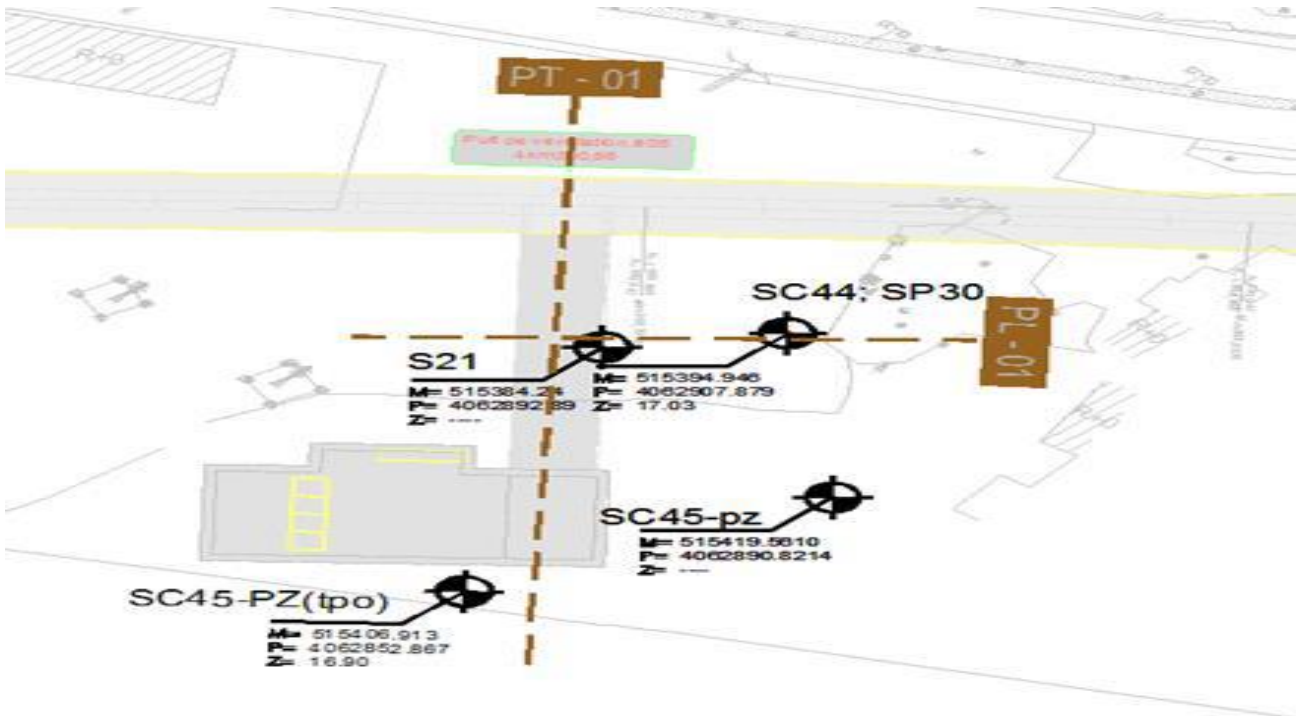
Plan d'implantation des sondages du puits de ventilation 05
